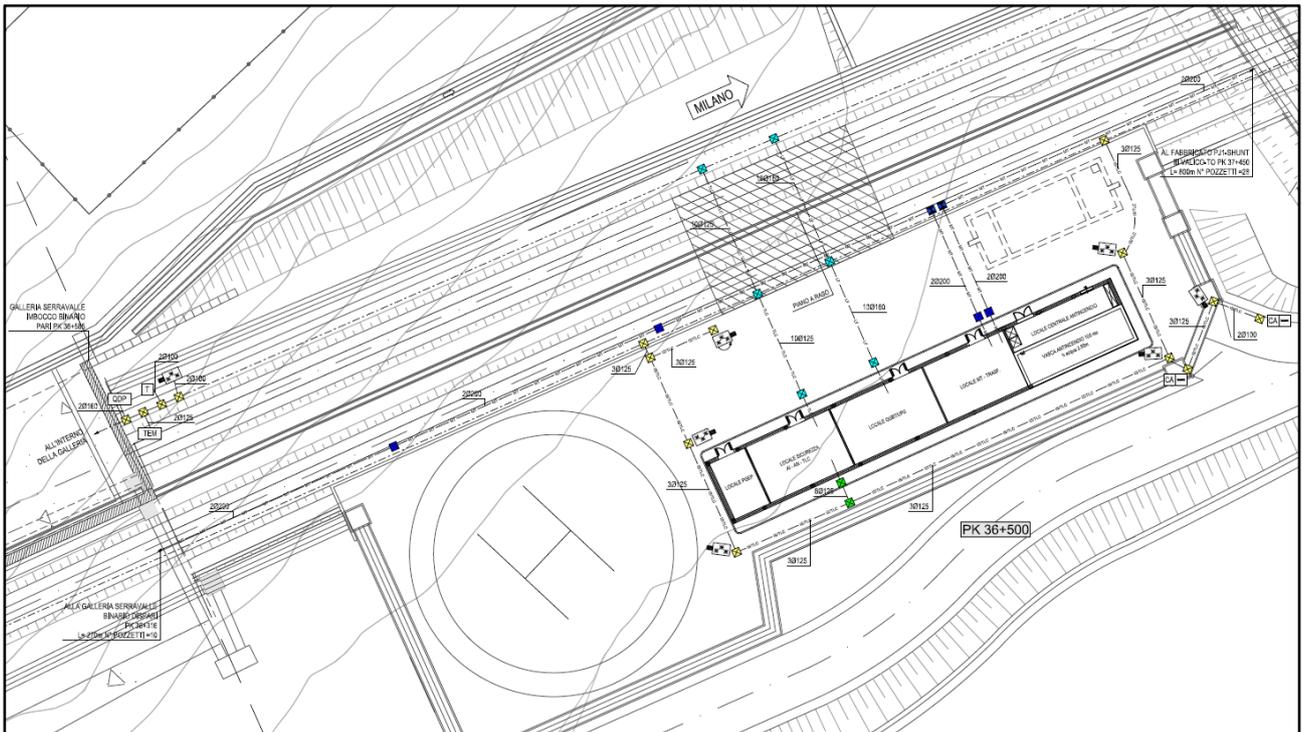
PLANIMETRIA DI PROGETTO PDAI
